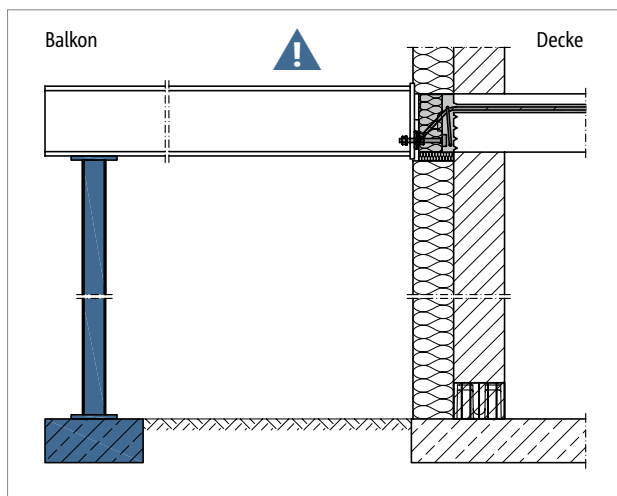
Schöck Isokorb® RT Typ SQ: Stützung durchgängig erforderlich
